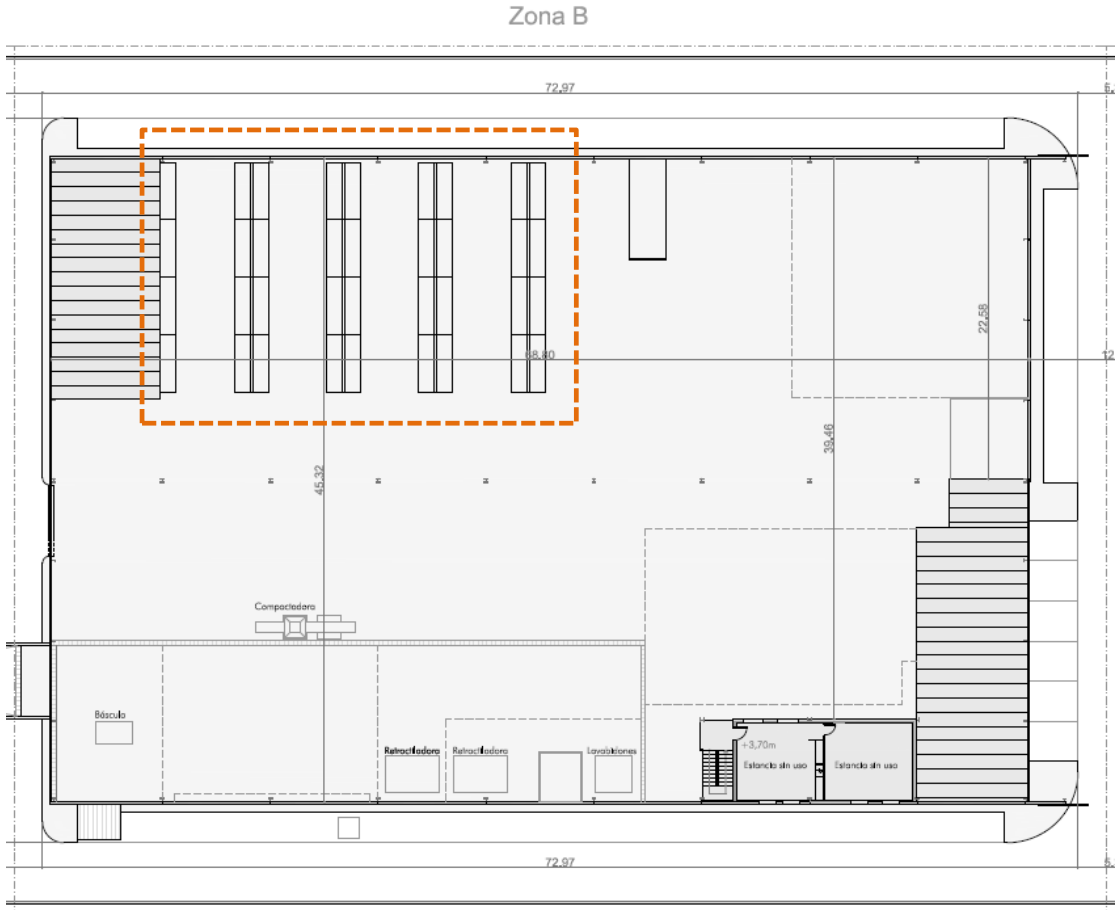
PLANTA ZONA DE ESTANTERÍAS
